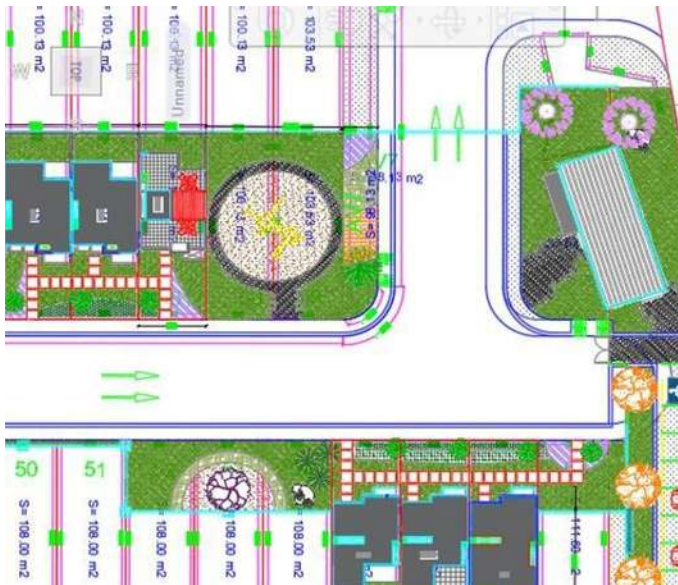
Planta de conjunto área de ventas y casas muestra del condominio Apis de la constructora Urbana donde ejecute el puesto de supervisor de obra.
